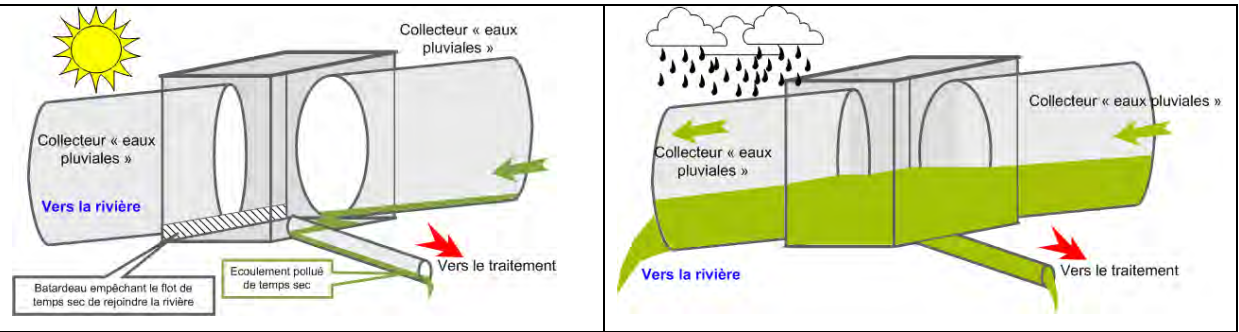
Schéma simplifié d'une prise de temps sec sur collecteur pluvial
